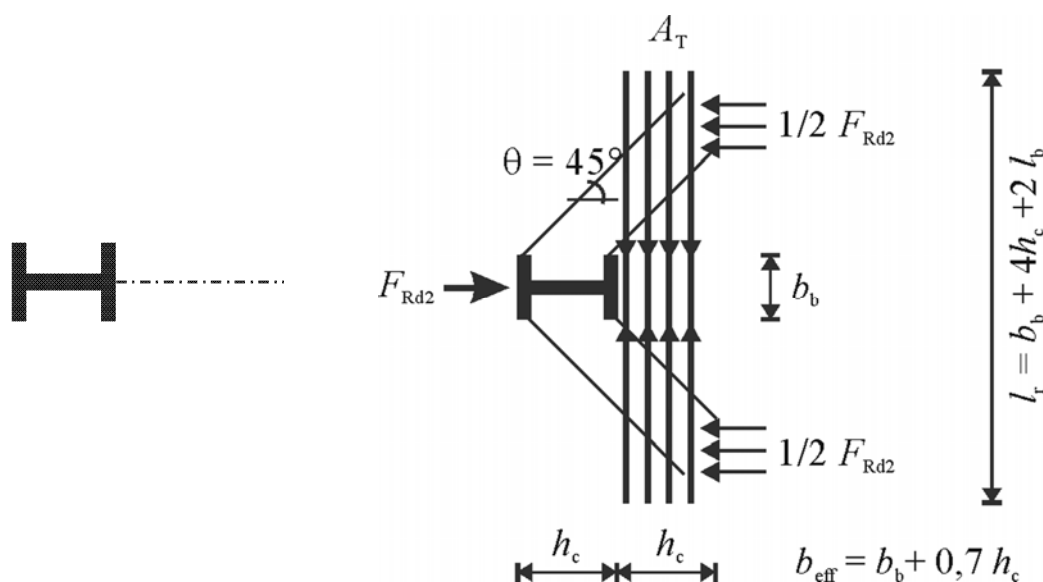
Mécanisme 2 : la compression en dehors de la largeur de la face du poteau est équilibrée par des bielles de béton comprimées et des armatures tendues.
